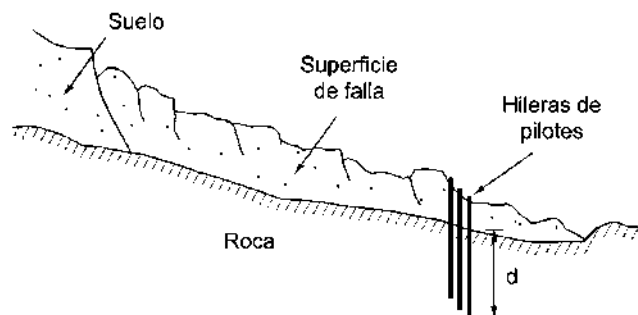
Estabilización de un deslizamiento mediante pilotes.
